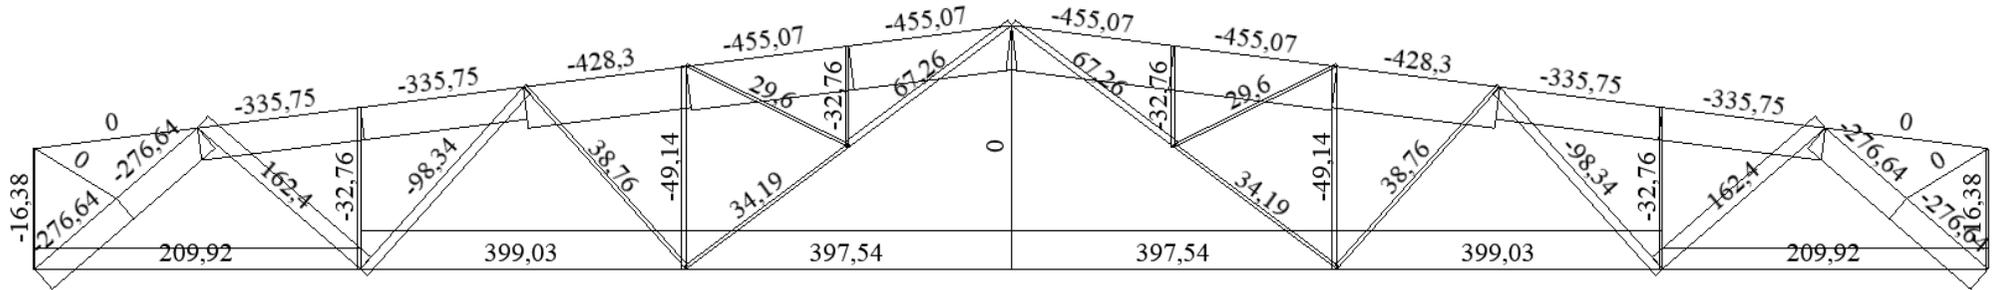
Эпюра внутренних усилий от снеговой нагрузки
